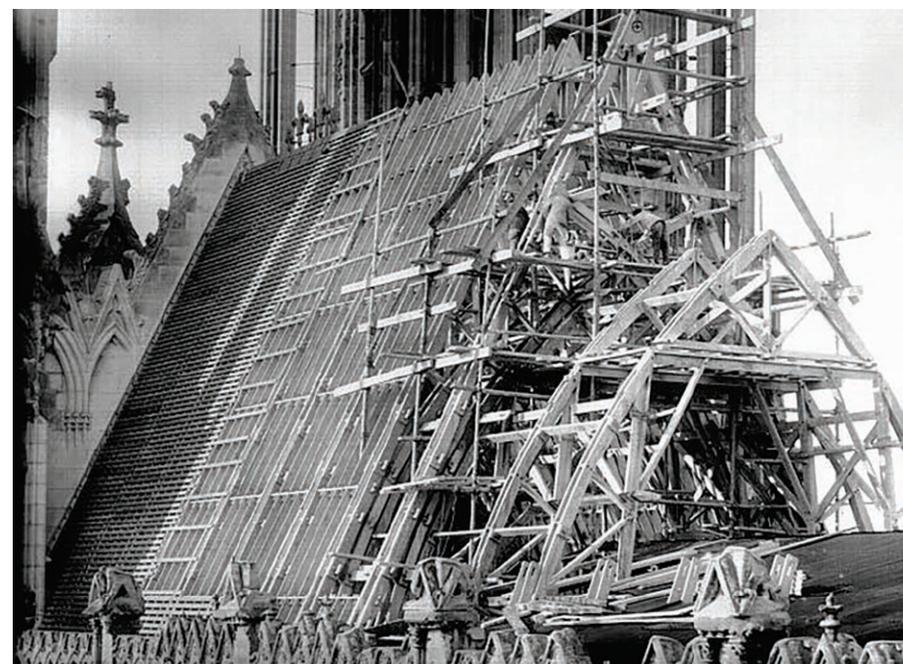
Vista de la nueva estructura de hormigón armado de la Catedral de Reims (Fuente: Arroyo, 2020)
